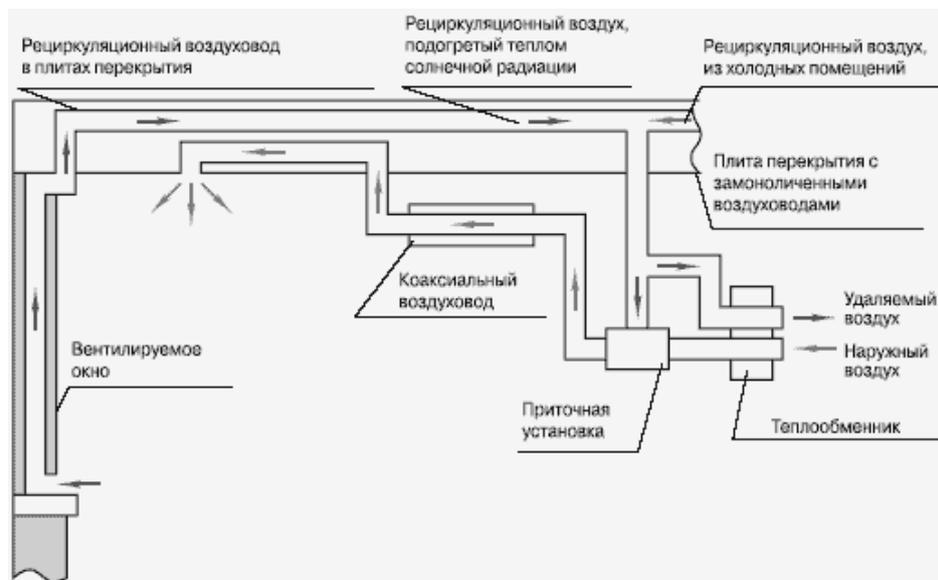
Схема организации воздухообмена в помещении здания с использованием вентилируемых окон и пустот в плитах перекрытий
